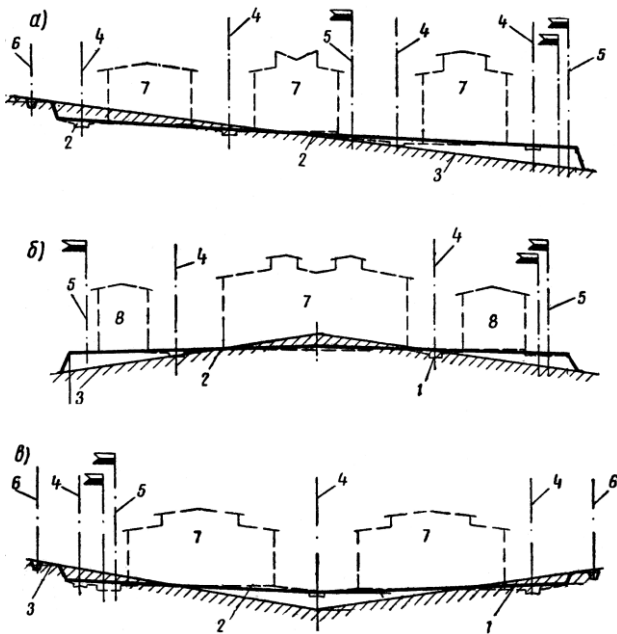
Безтерасові схеми вертикального планування [53]:
